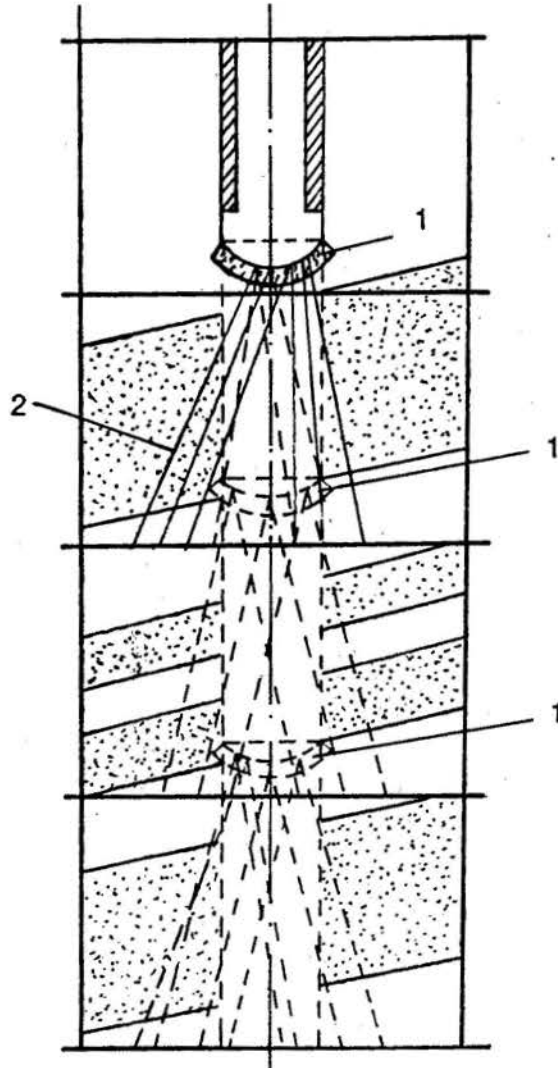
Cementación desde el frente del pozo con la construcción de una almohada de hormigón. 1-almohada de hormigón, 2-taladros de taponamiento.
